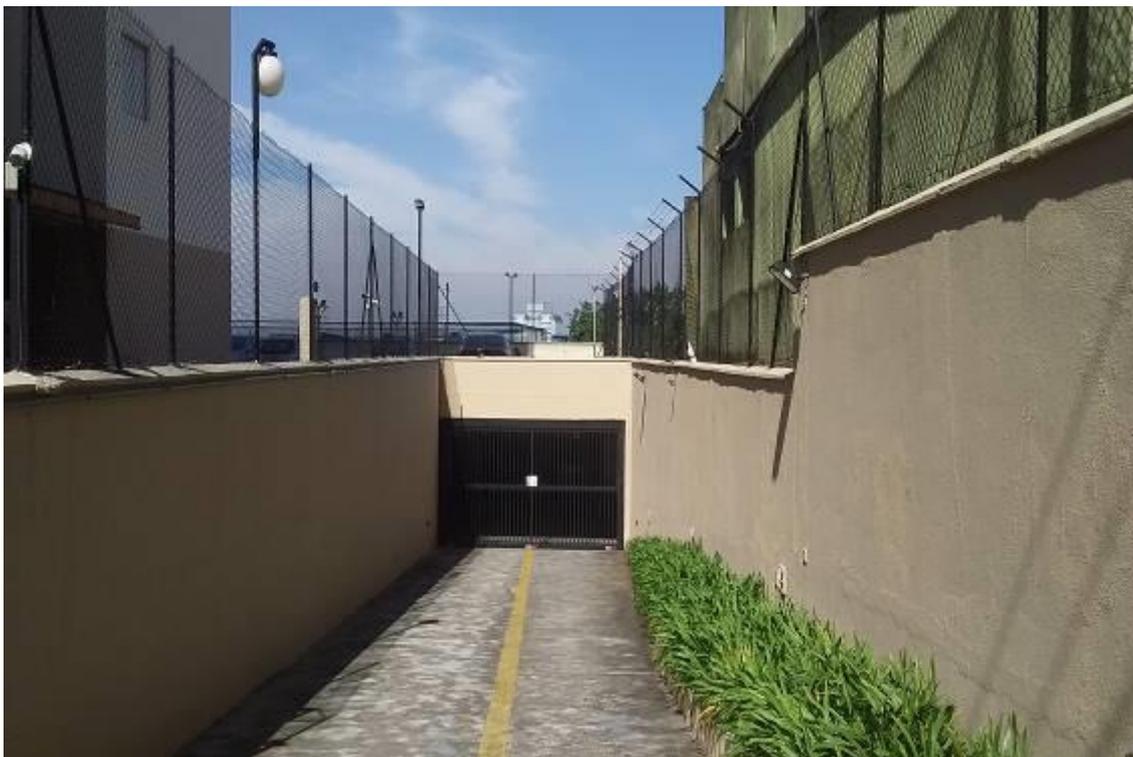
Vista da rampa de acesso à garagem do subsolo.
